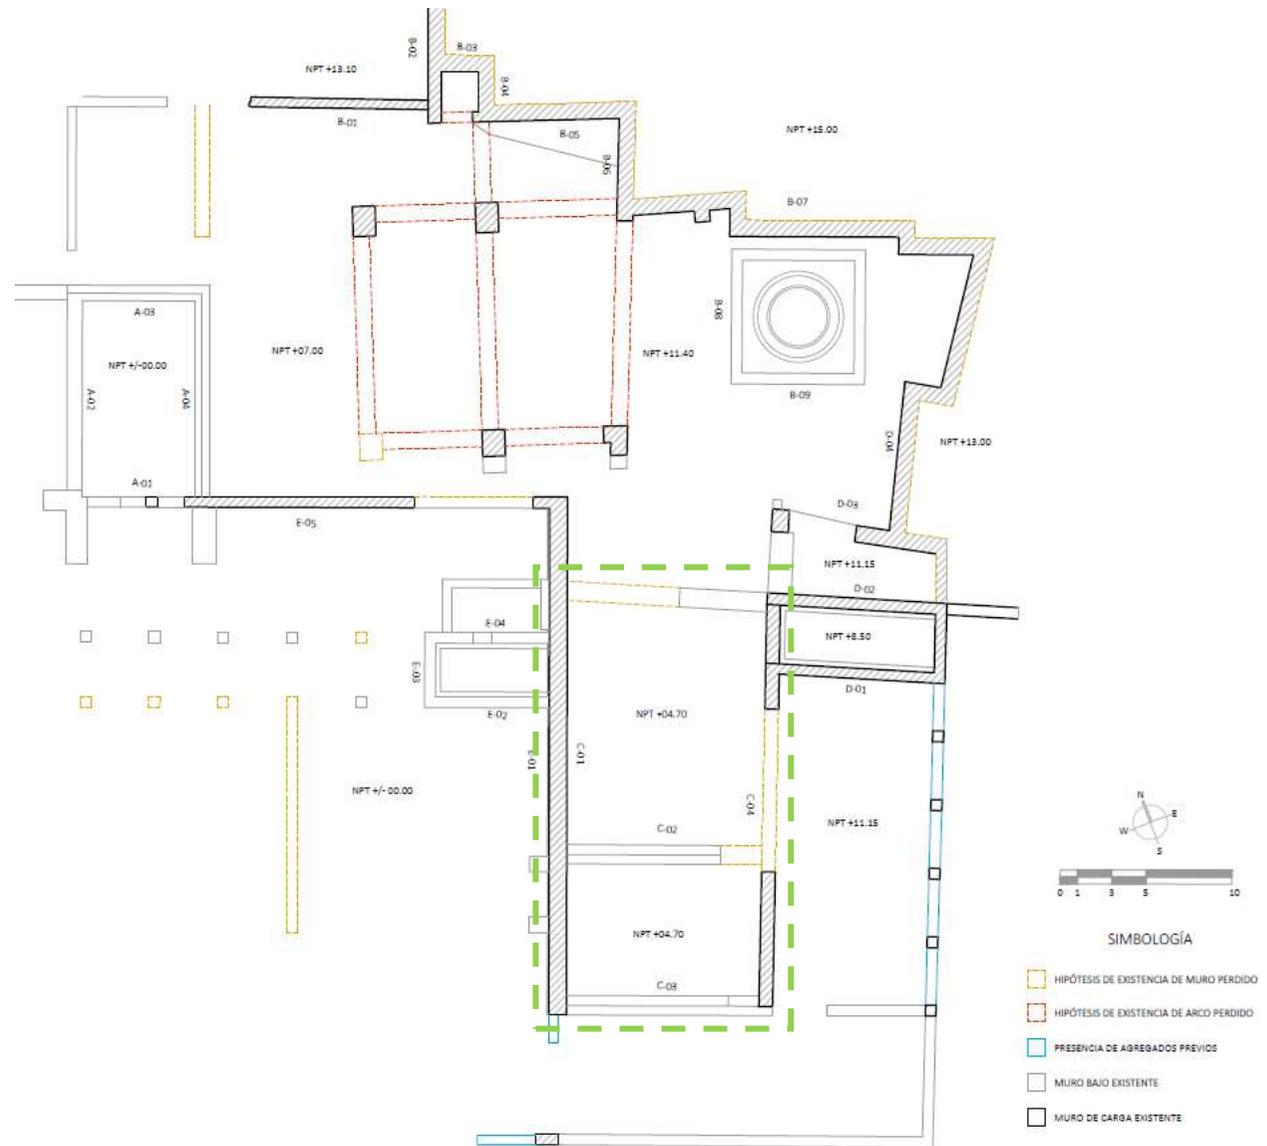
Planta de la zona de estudio. El área seleccionada corresponde al tanque de agua.
